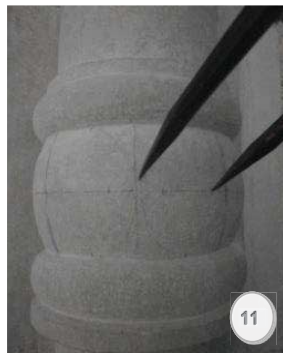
Trazado de la red geométrica que envuelve la esfera.
